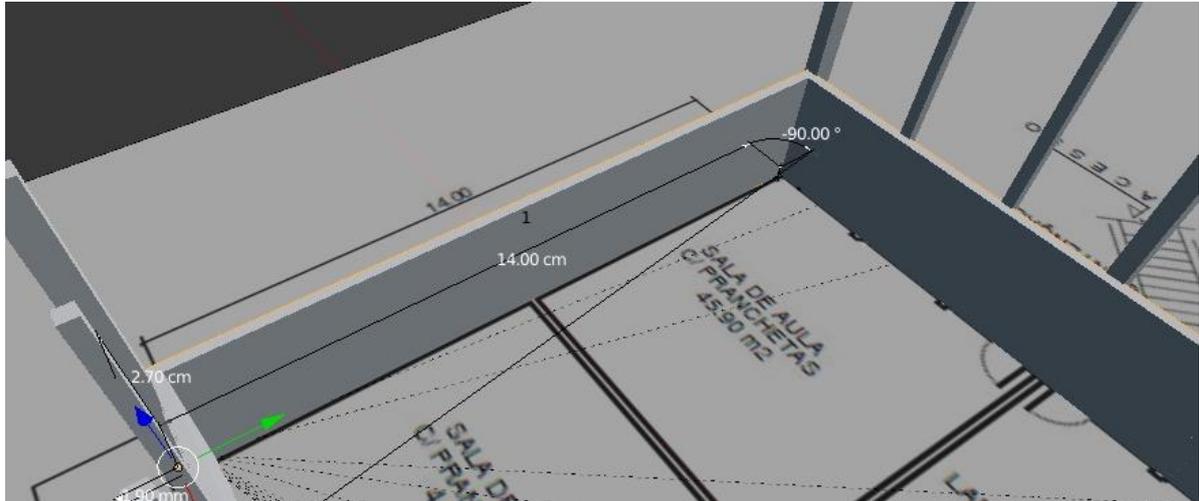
Vista em perspectiva da estrutura base do prédio 14 usando ArchPack no Blender.
